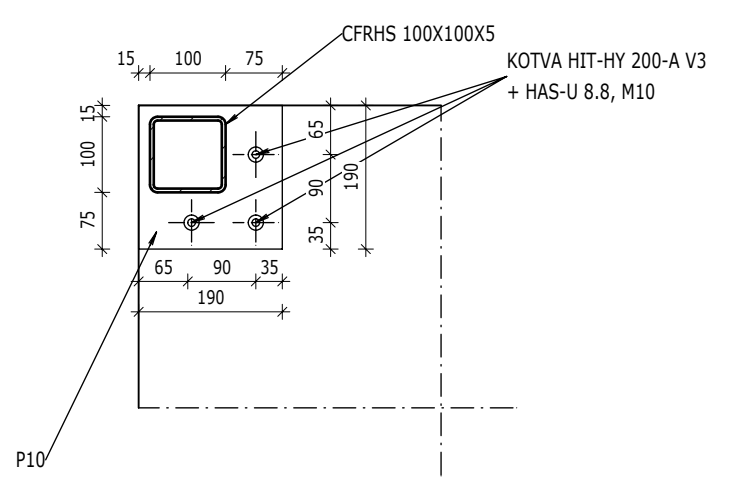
PATKA F2, PAS ZP1, PAS ZP2
